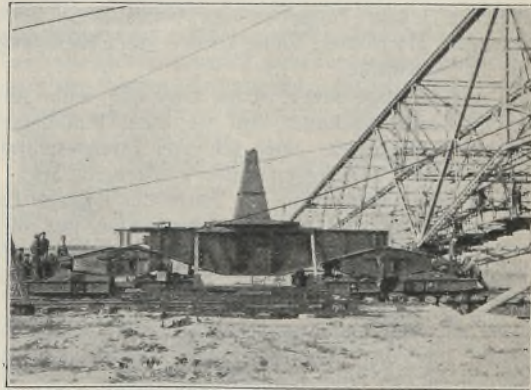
Fahrwerksträger der Brücke „Hansa“ mit Königsstuhl und Ringträger (Baggerseite).
